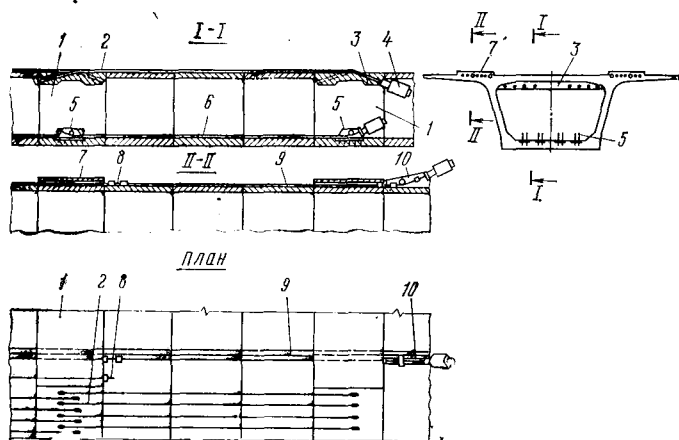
Схема установки напрягаемой арматуры на участке балки:
